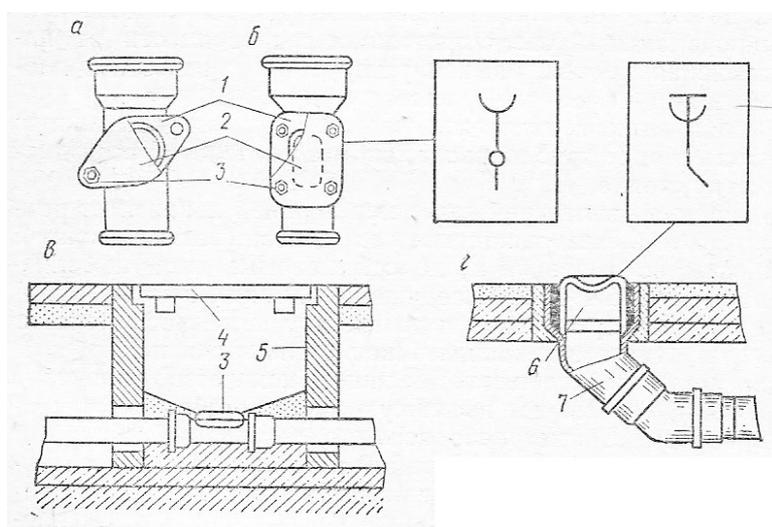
Ревизии и прочистки а) вертикальные с наклонной крышкой, б) вертикальные прямоугольные, в) колодезные, г) горизонтальные: 1 - резиновая прокладка; 2 - крышка; 3 - болты; 4 – крышка колодца; 5 - колодец; 6 - заглушка; 7 - отвод
